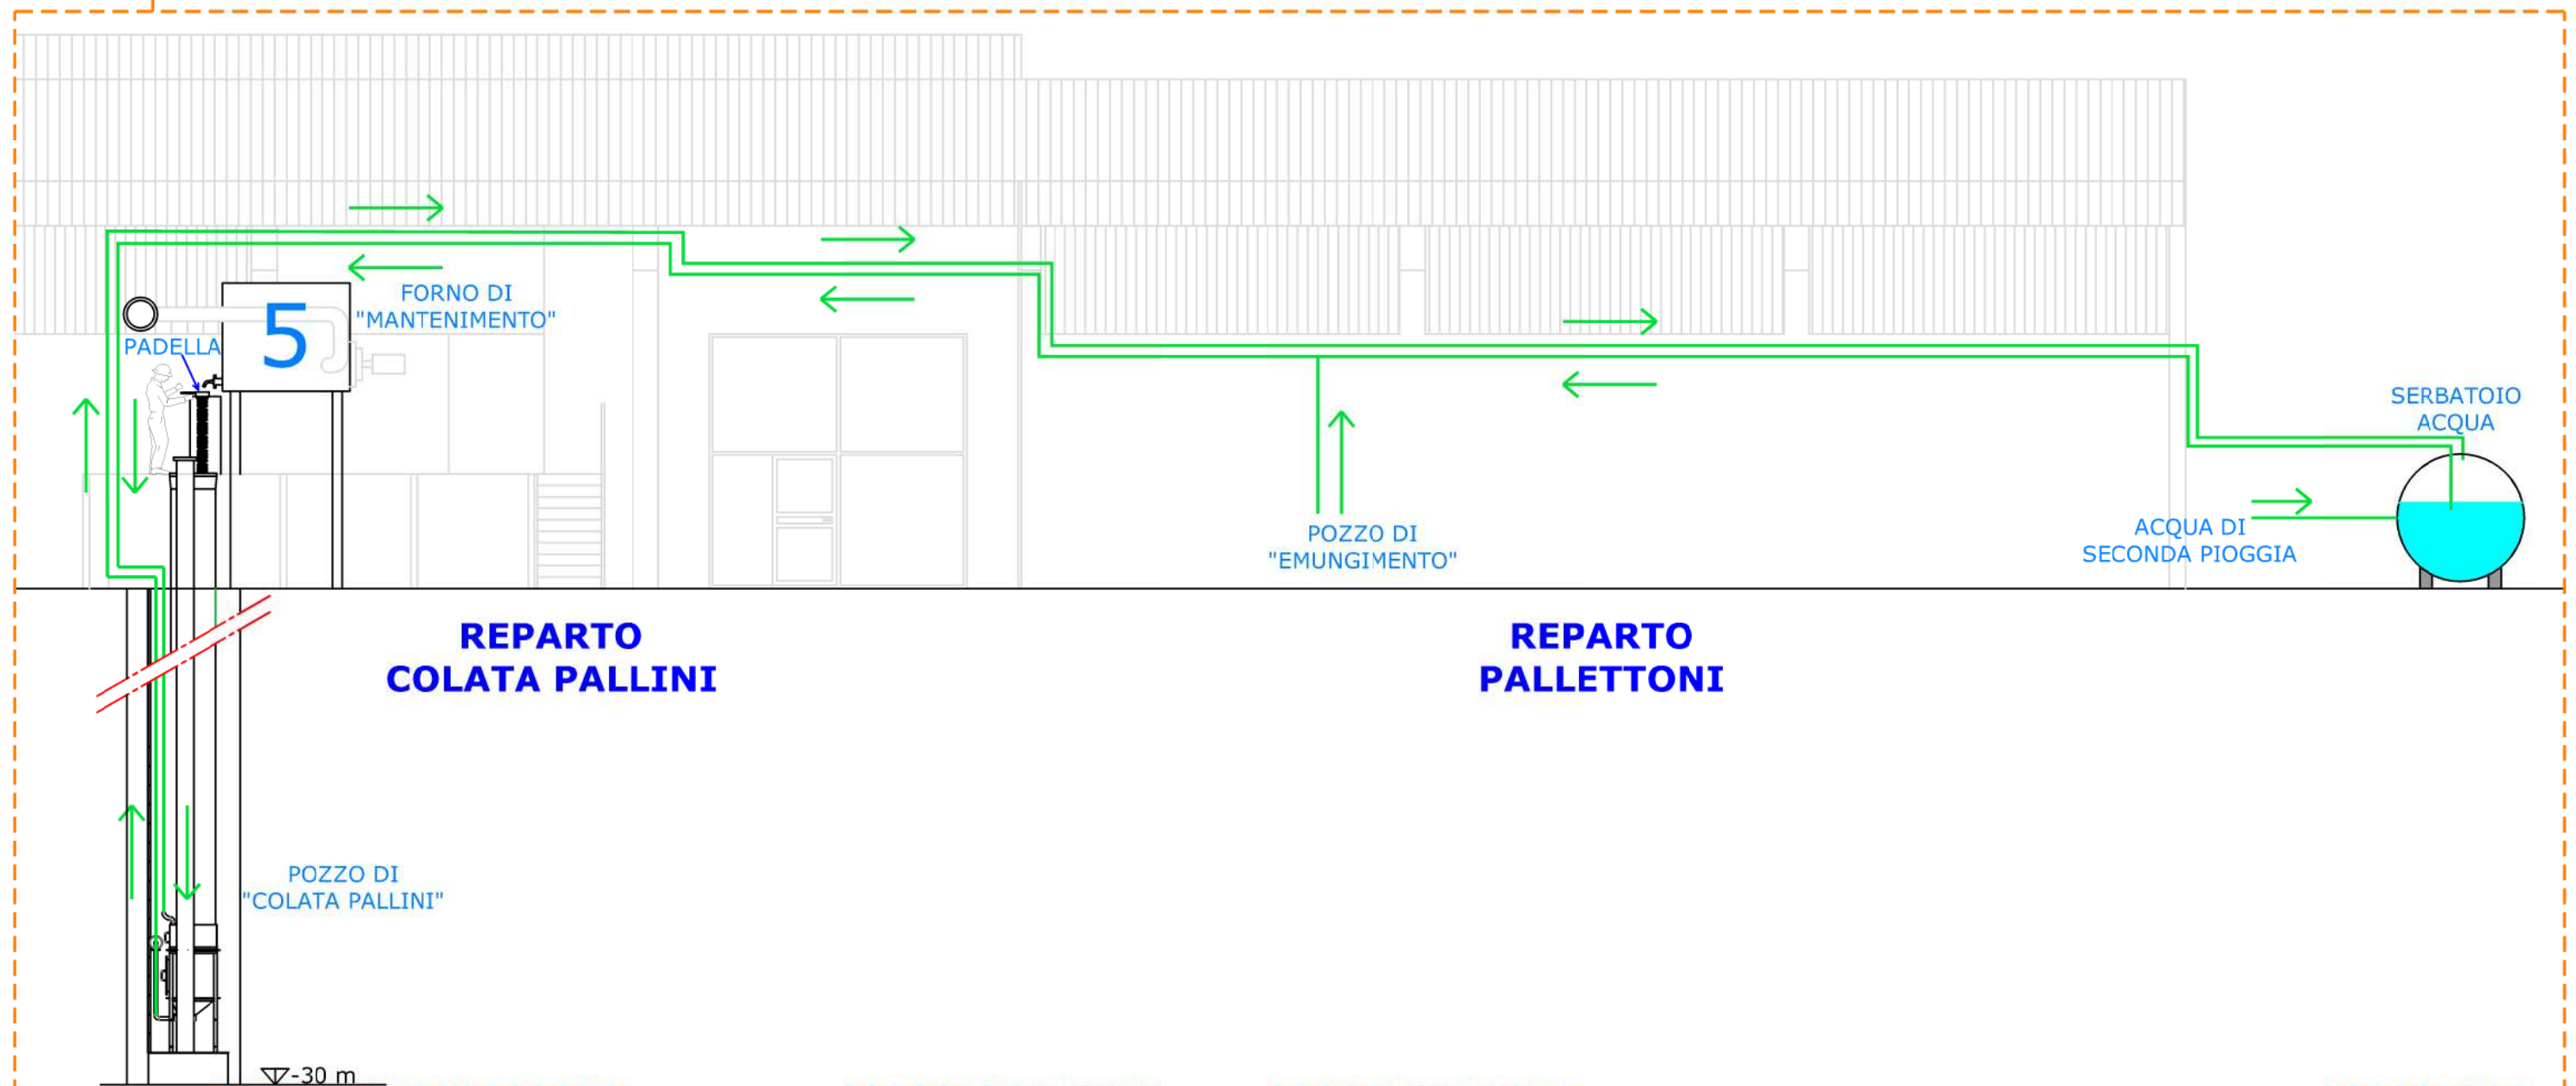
STRALCIO PLANIMETRIA GENERALE TEAM ITALIA
